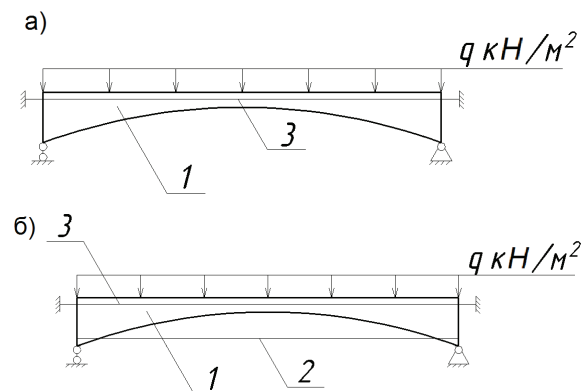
Испытательная схема арочного фрагмента перекрытия:
